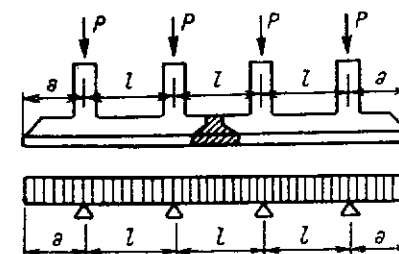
Fundație continuă de beton armat sub stâlpi (detaliu de armare).
